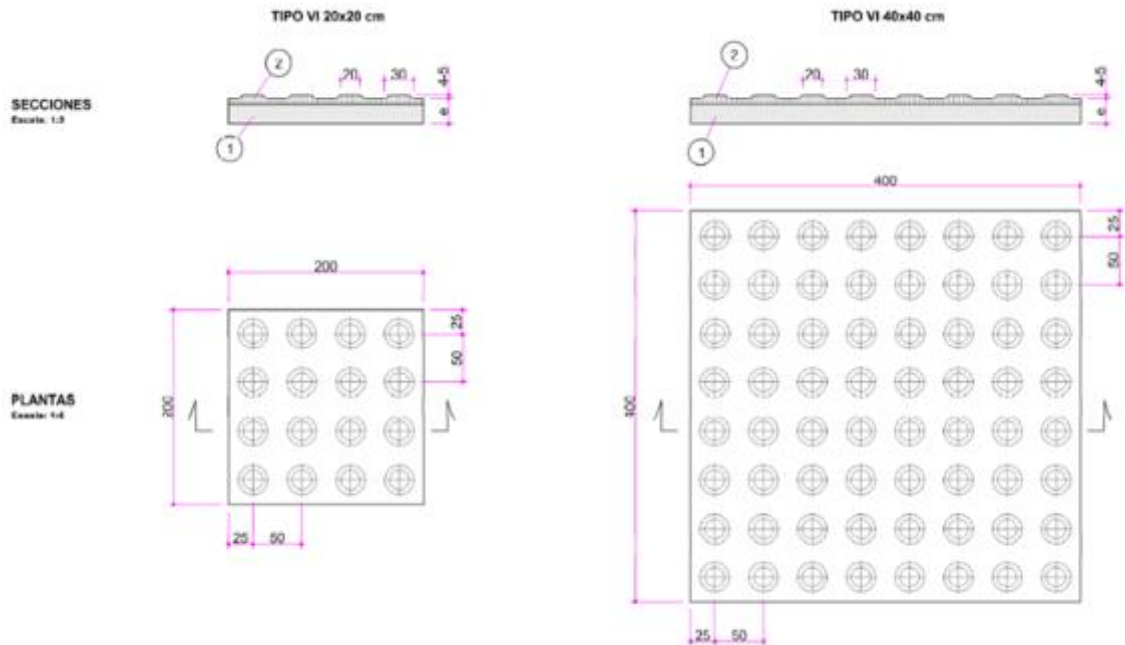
Pavimento tacto visual advertencia de botones según NECOU (geometría)
